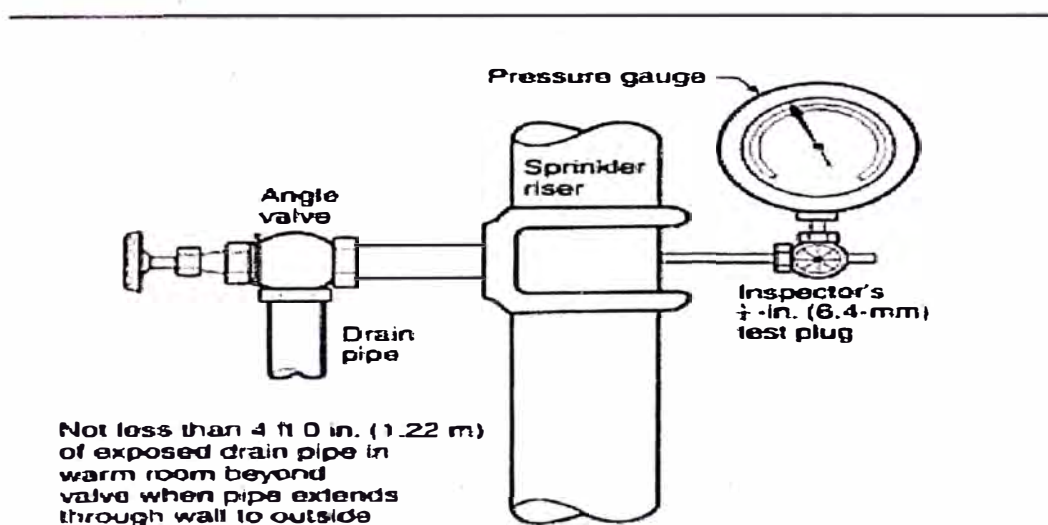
Conexión de drenaje para sistema de tubería húmeda
